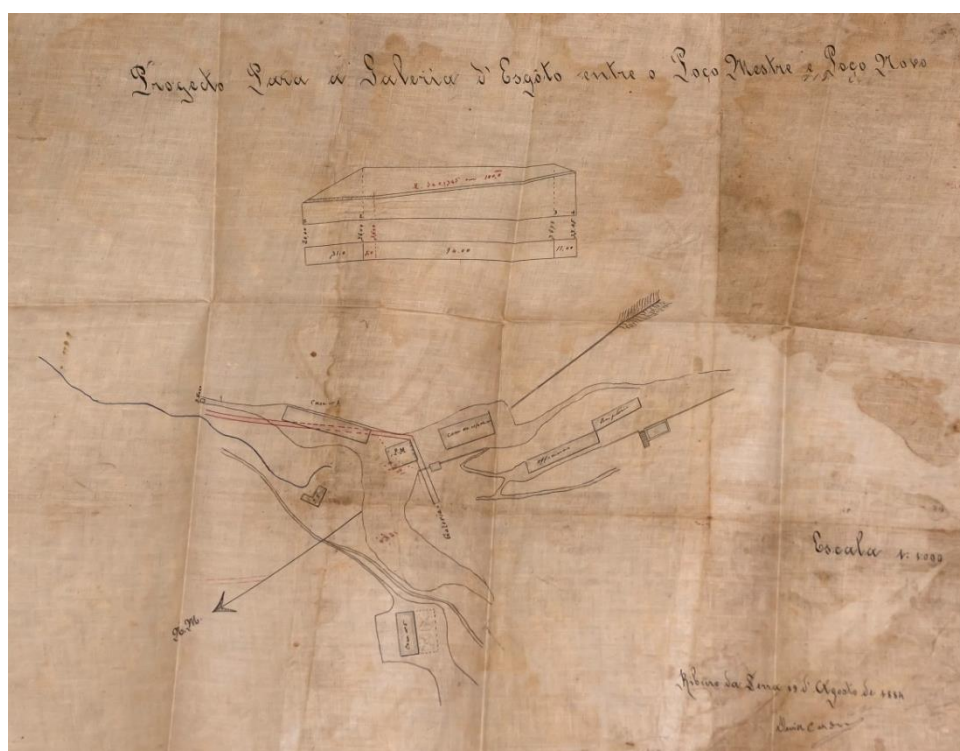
Planta de uma parte das explorações na mina do Ribeiro da Serra em 1884.
